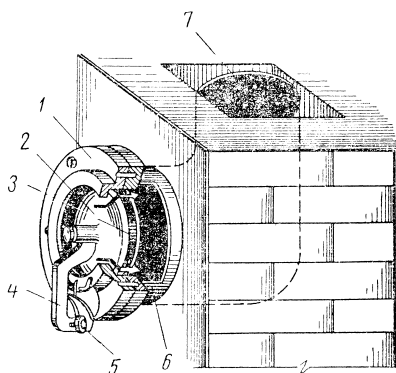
Клапан избыточного давления КВД (схема установки в начале вытяжного канала санузла; стрелками показано направление движения воздуха из убежища): 1—корпус клапана; 2—диск; 3—резиновая прокладка; 4—рычаг, соединяющий диск с корпусом клапана; 5—груз-противовес для регулирования положения диска, 6—металлическая труба; 7—вытяжной вентиляционный канал
